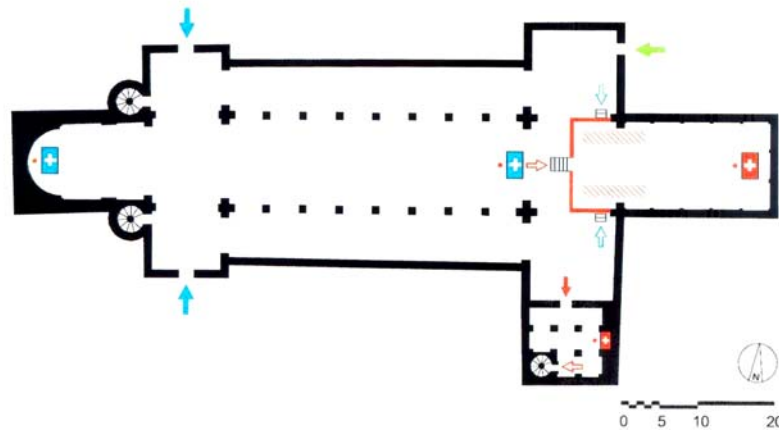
Paderborn Dom, Grundriss Bauzustand 1068. Repro aus:
